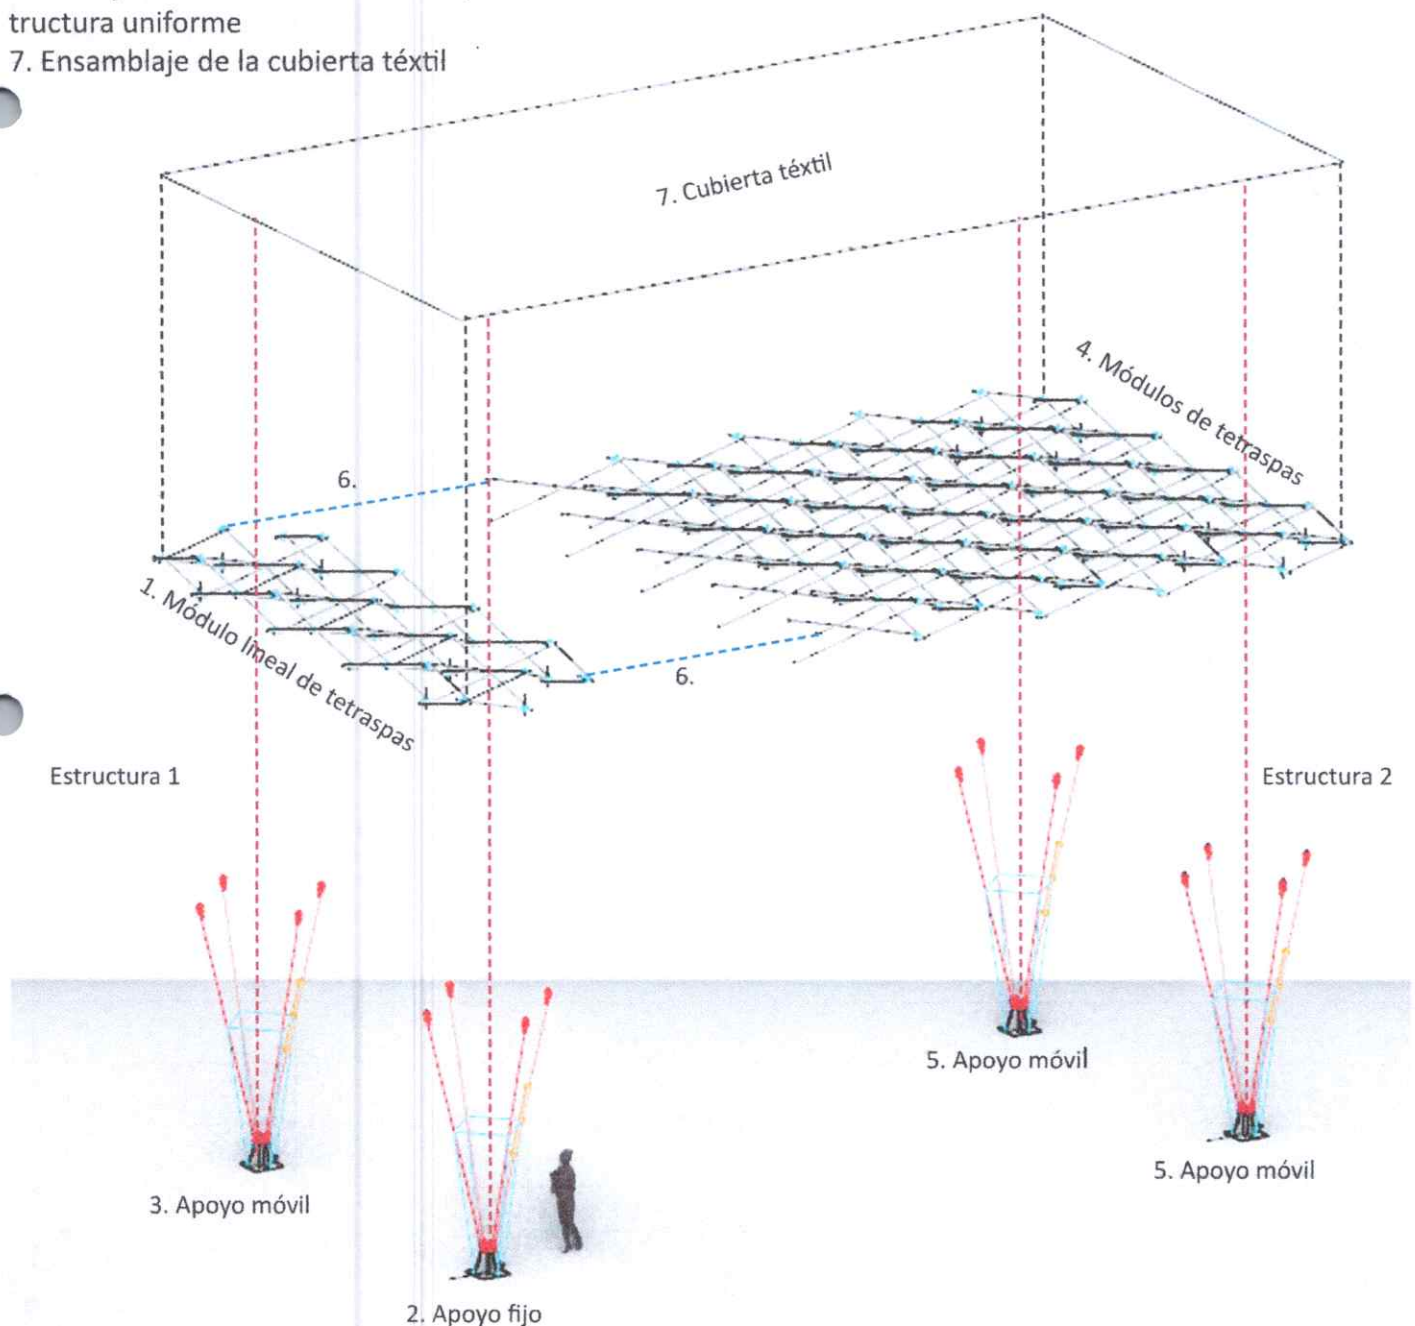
Proceso de ensamblaje y construcción de prototipo desplegable
